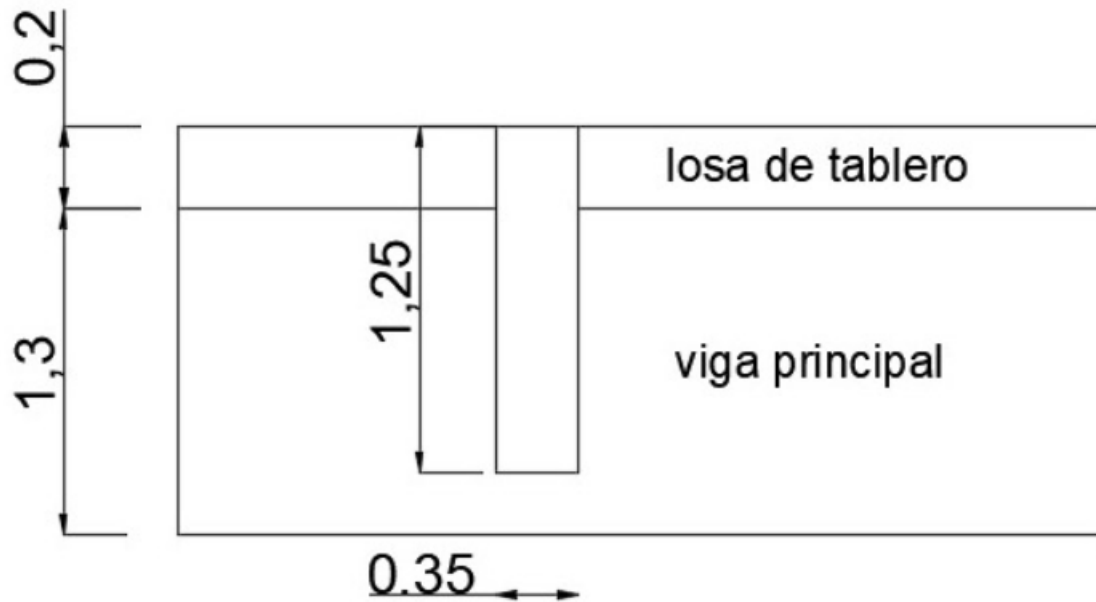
Viga secundaria en sección longitudinal (fuente: Elaboración propia)
